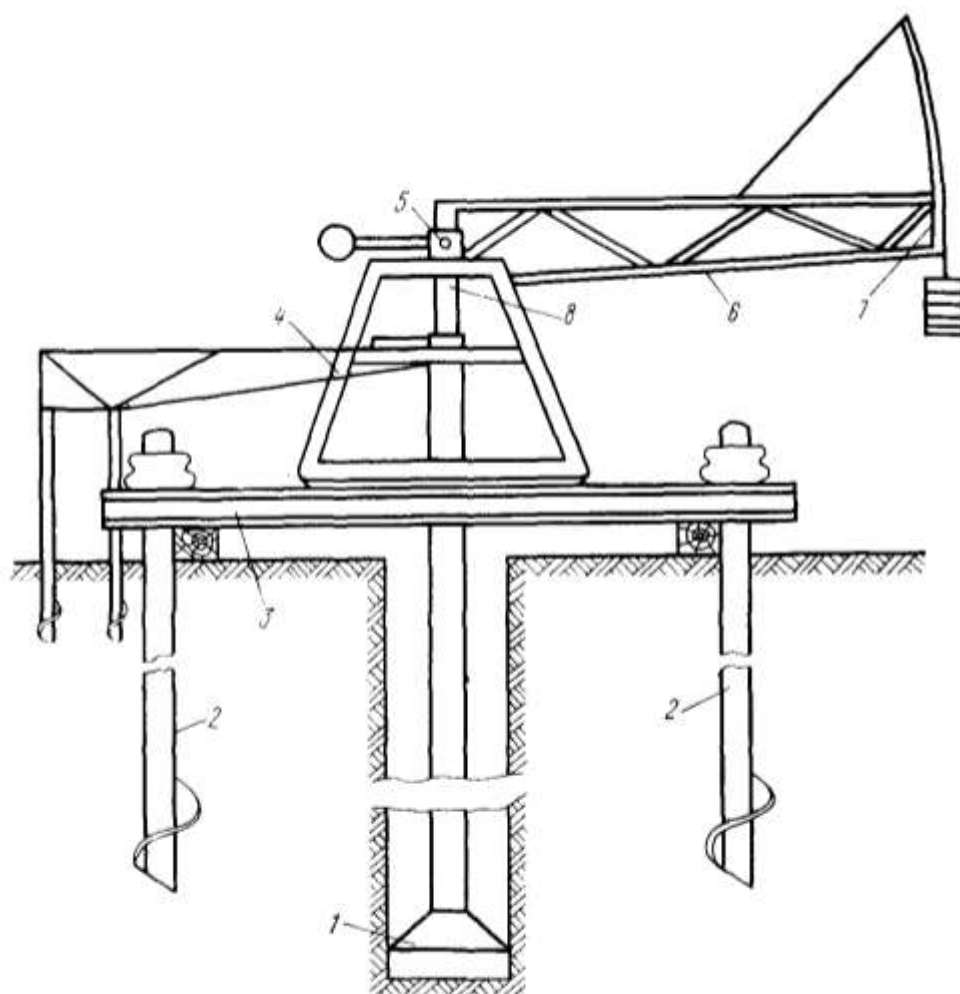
Канатно-рычажная установка КРУ-600. 1 — штамп; 2 — анкерные сваи; 3 — опорные балки; 4 — рама; 5 — ось рычага; 6 — загрузочный рычаг; 7 — грузовой сегмент; 8 — штанга
